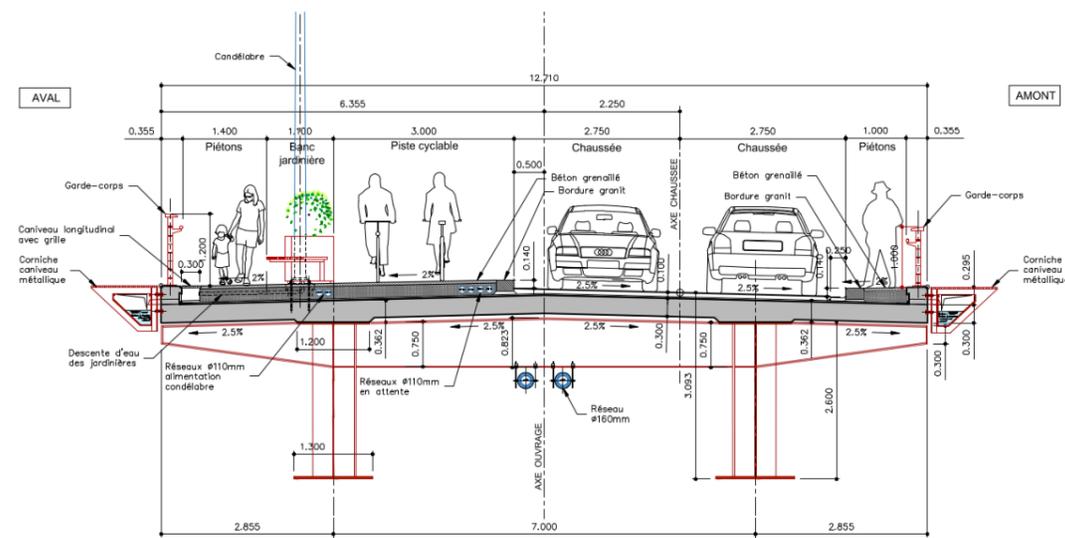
Système de recueil des eaux pluviales - Extrait Plans AVP (Ingérop)
